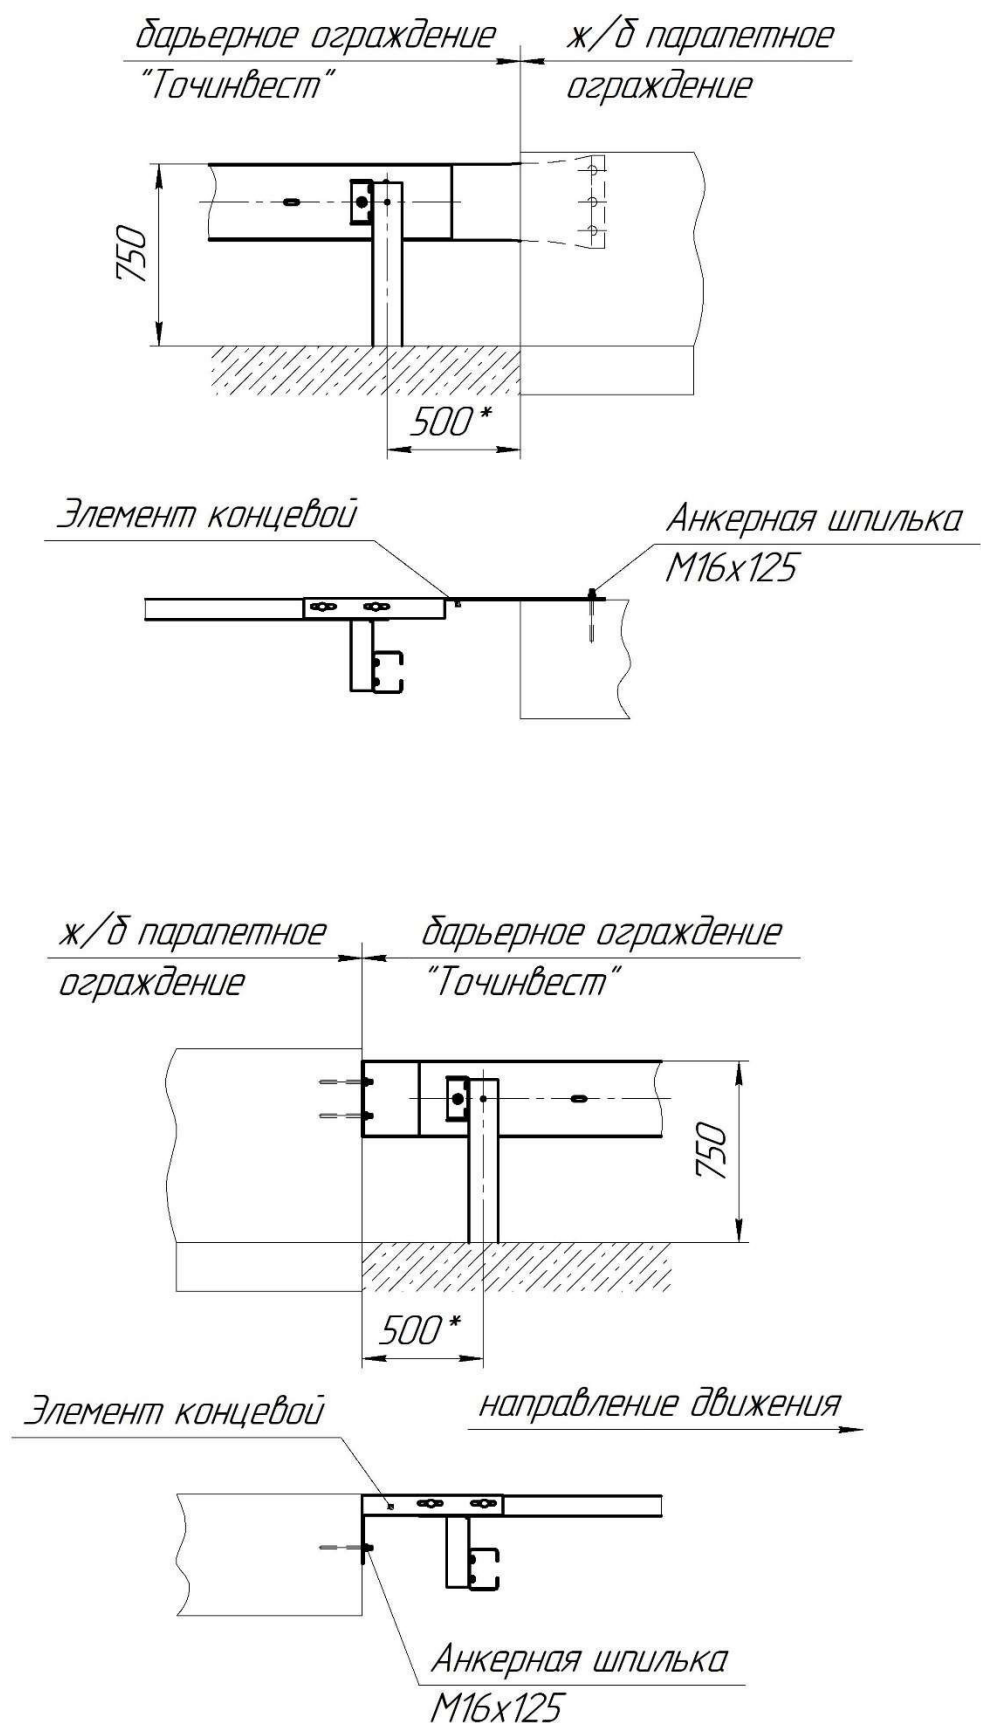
Схема соединения барьерного ограждения с железобетонным парапетным ограждением
